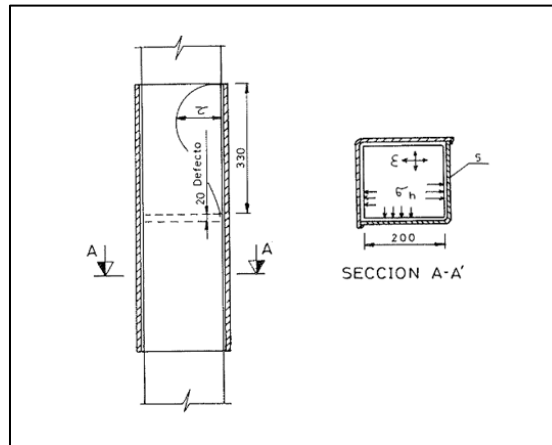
Elevación y sección de la columna reforzada. (Fuente: ATEP)
